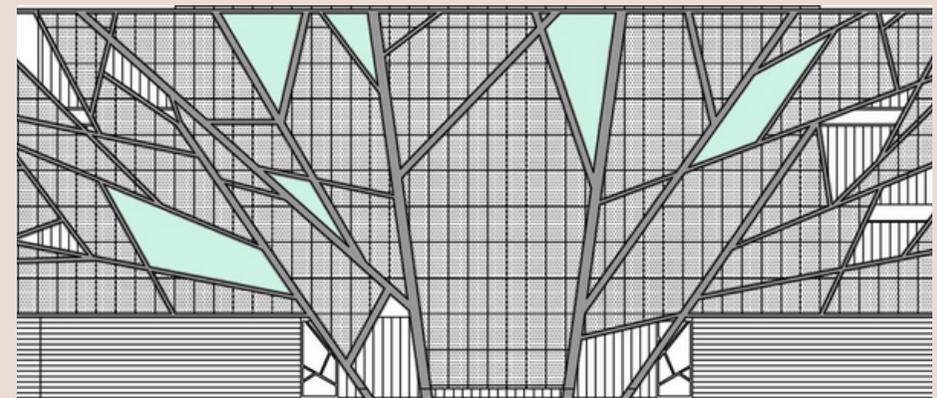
Fachada principal, disposição dos elementos. Fonte: Archdaily.
